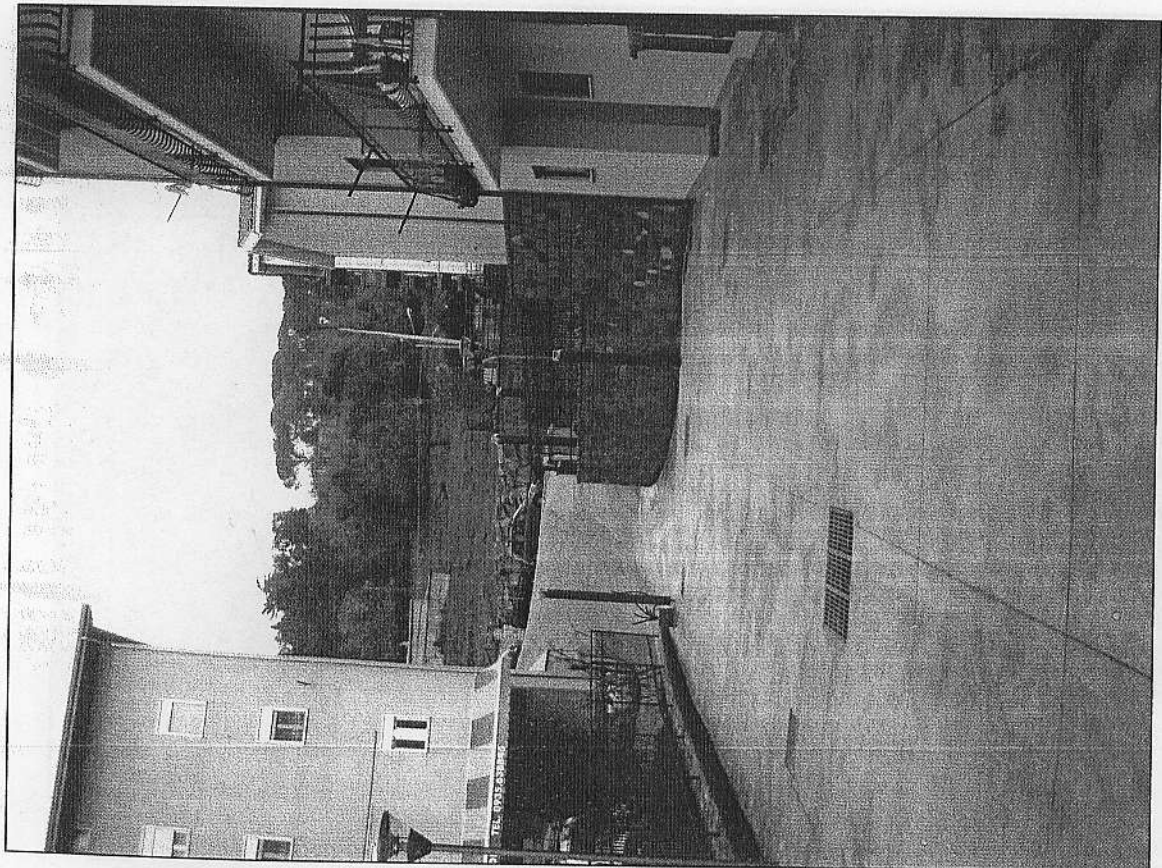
Vista prospettica del lato nord del piazzale pavimentato in battuto cementizio
